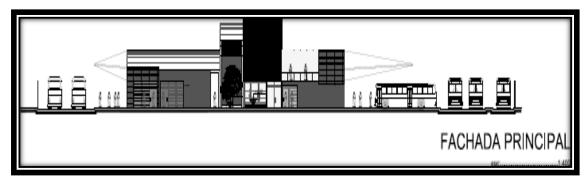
Planos del terminal Tipo 3 para el cantón Archidona (Fachada Principal) Fuente: (Túqueres, 2017).
